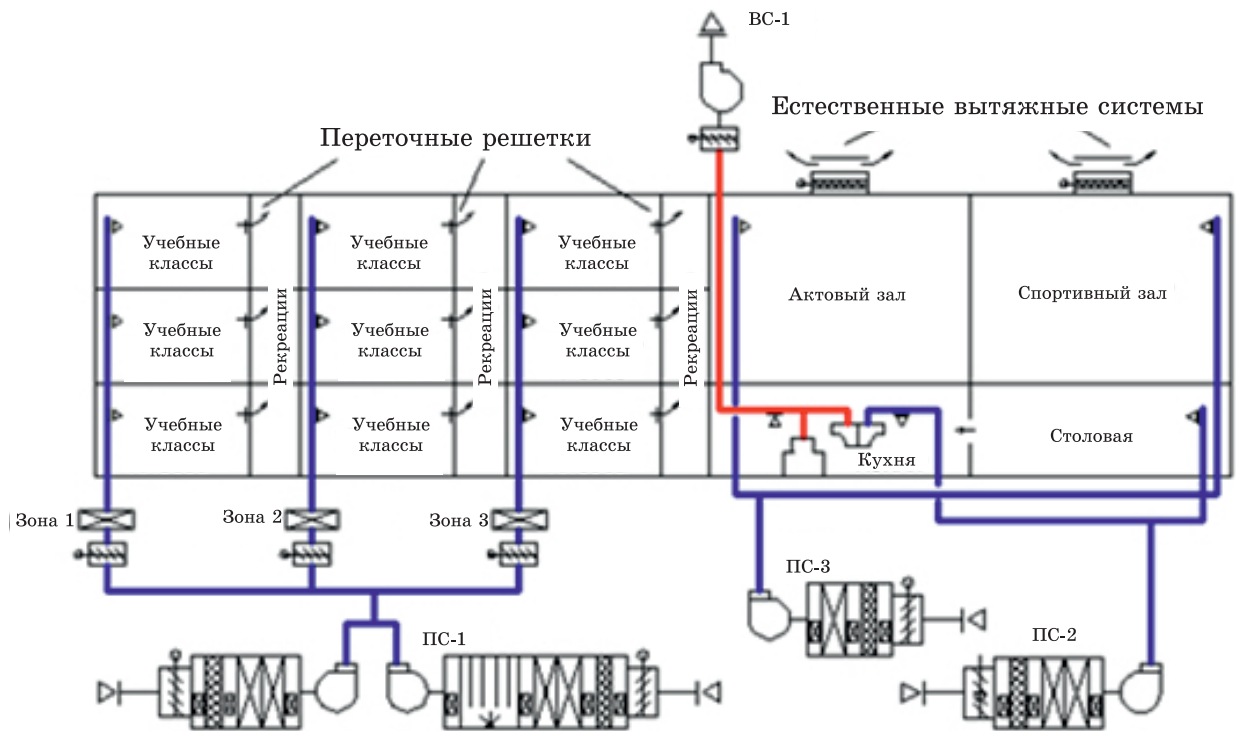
Принципиальная схема систем вентиляции и воздушного отопления школы по типовому проекту V-76
